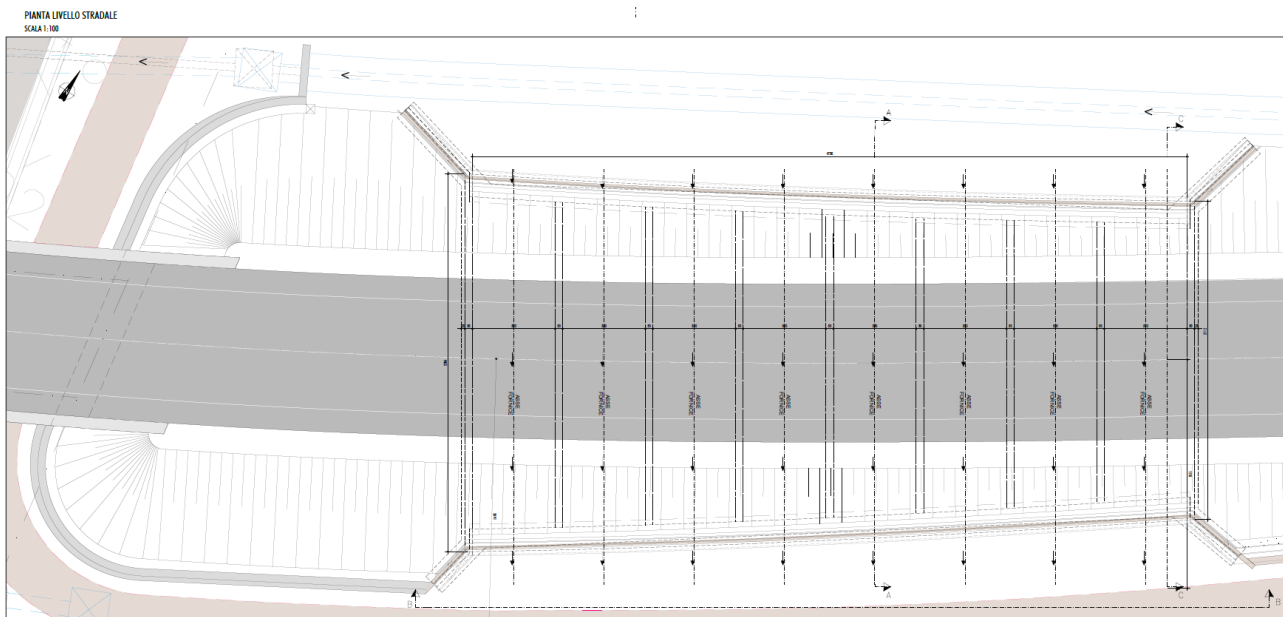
VISTA IN PIANTA DEL FORNICE N.4
